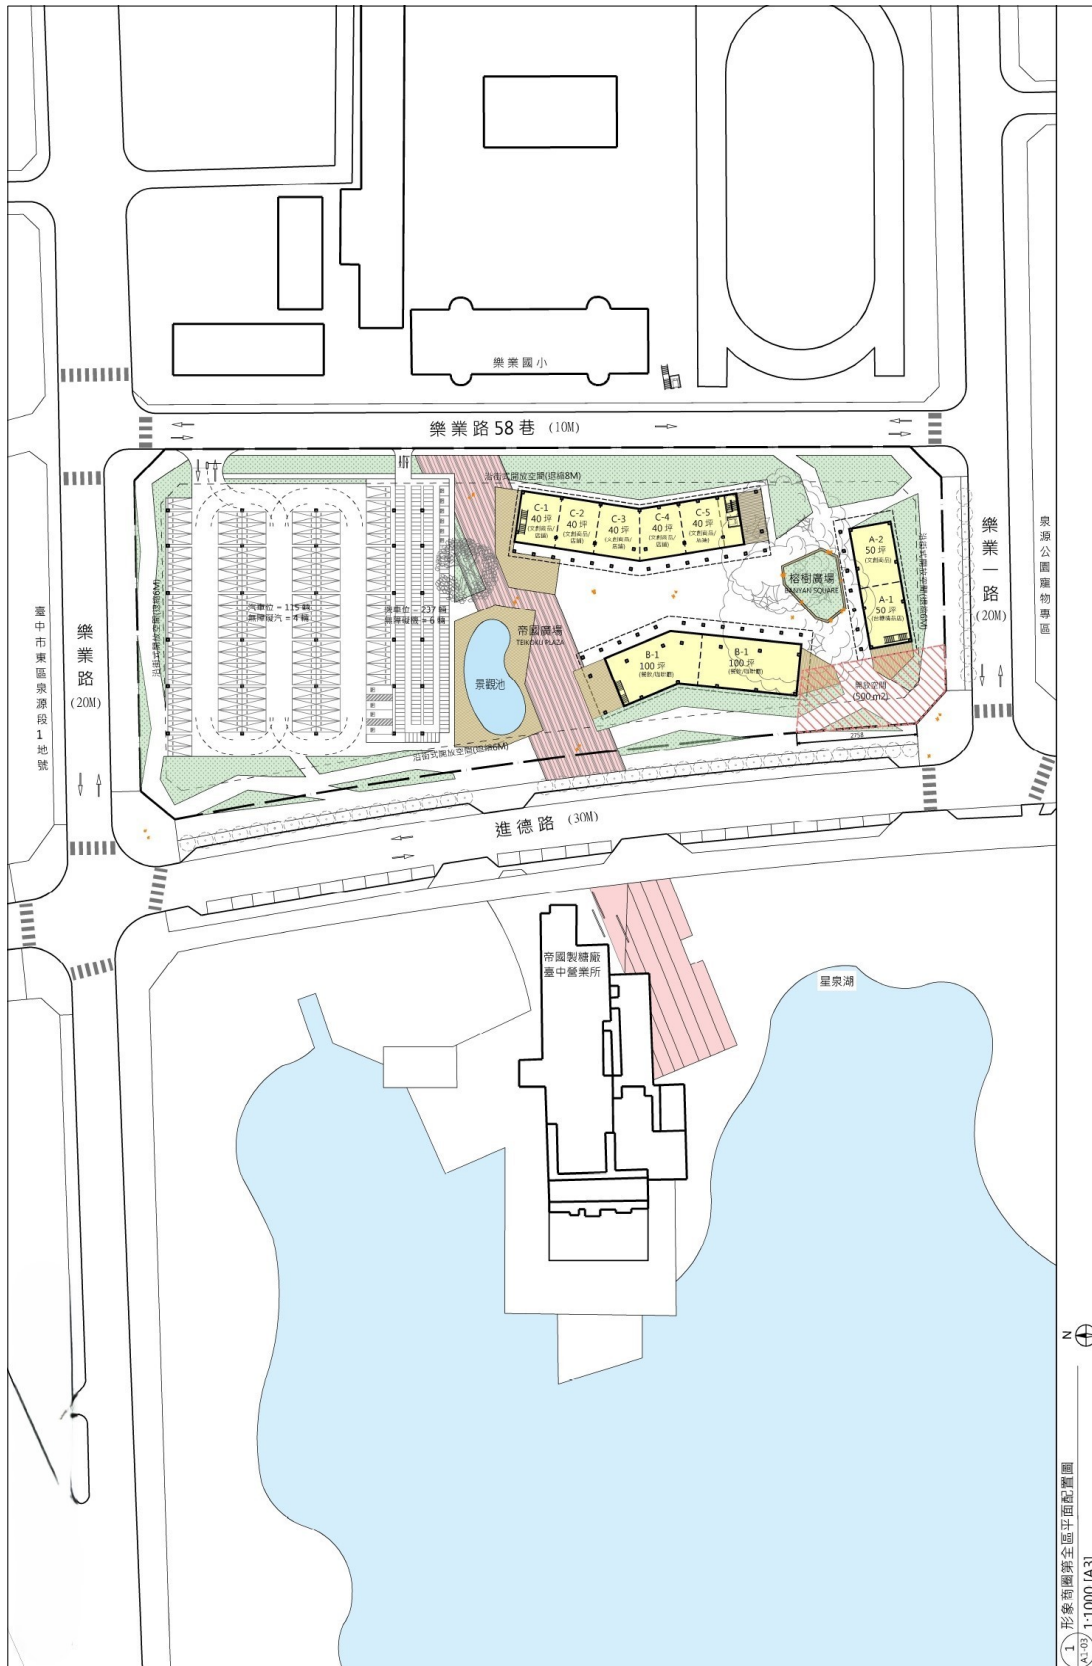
形象商圈全區平面配置圖(S：1/1000)
